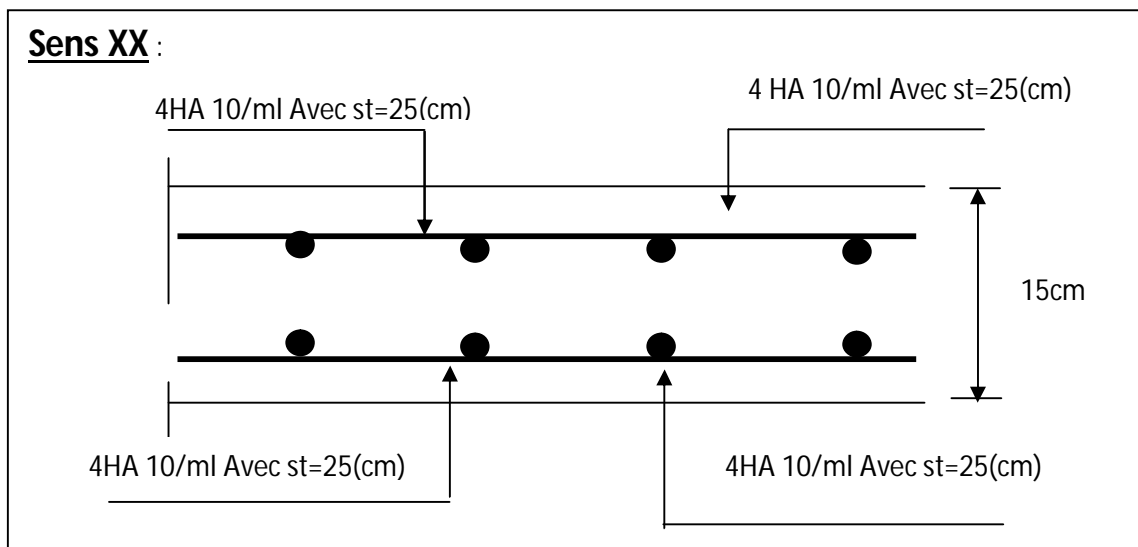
Ferrailage de la dalle pleine de la salle machine
